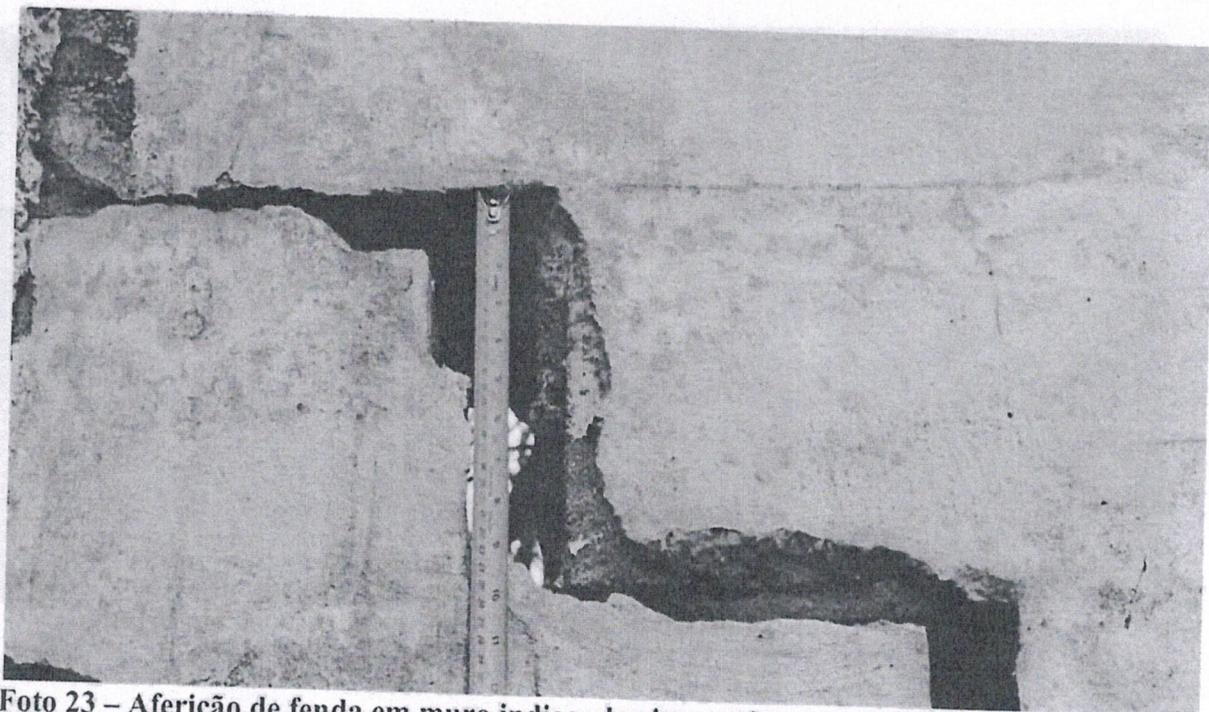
Aferição de fenda em muro indicando risco eminente de colapso estrutural – área de risco 9.
